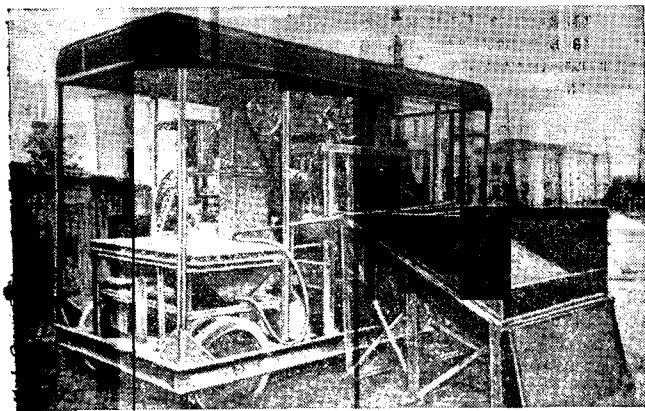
Внешний вид инвентарного штукатурного агрегата.
